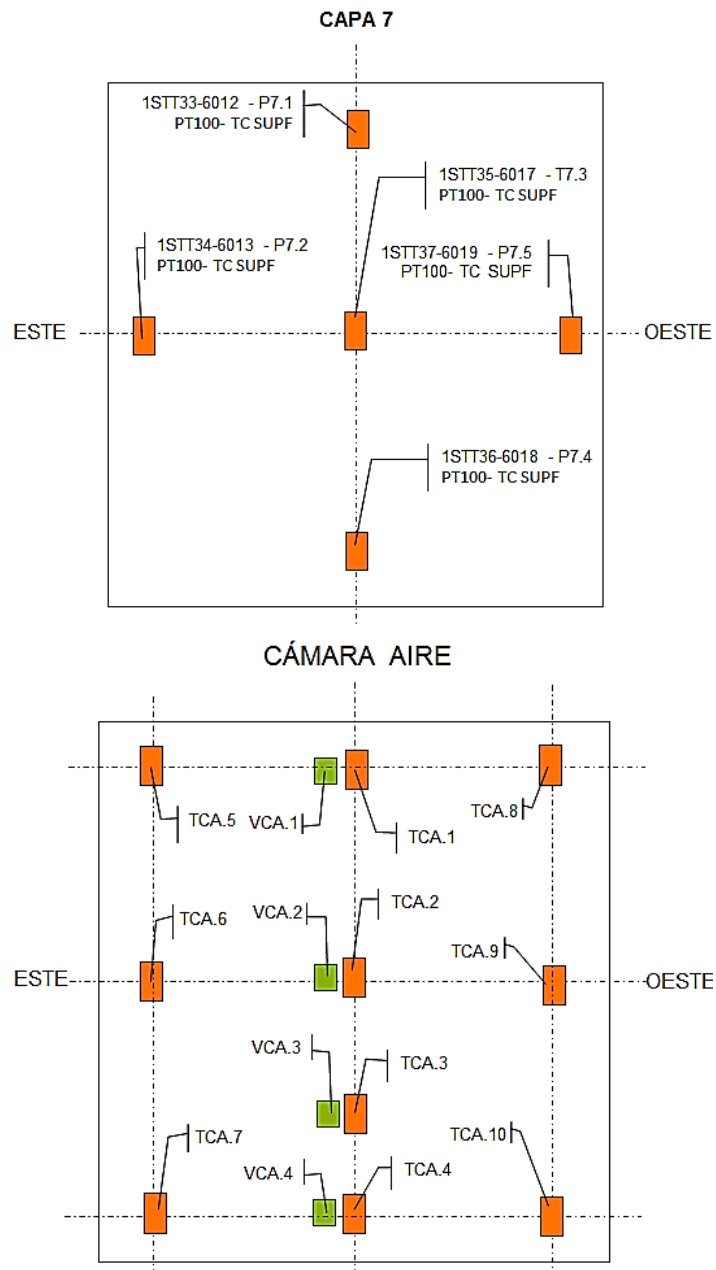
Instrumentación instalada en la fachada ventilada pesada
